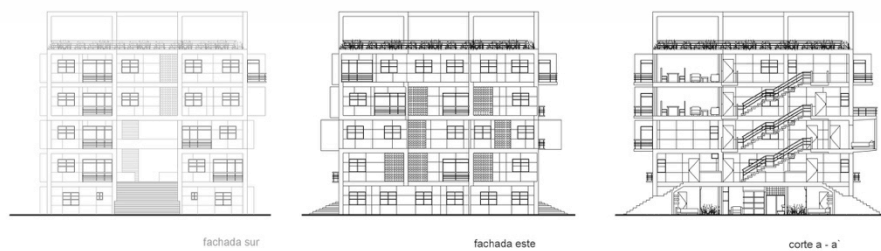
Fachadas y Corte Arquitectónicos de Módulo.
